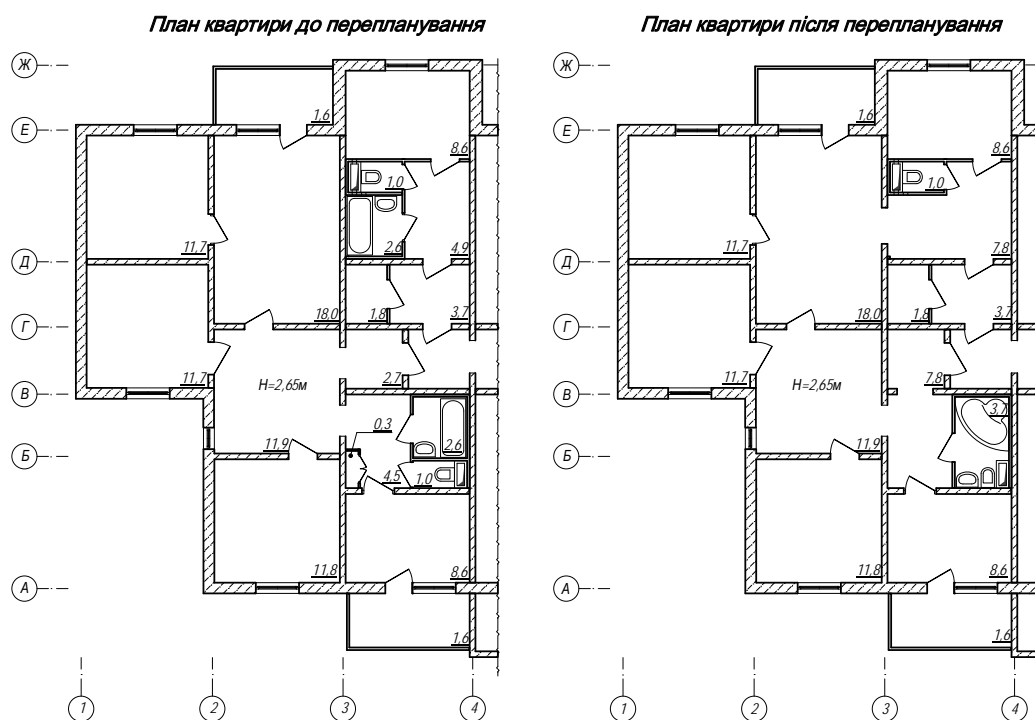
Найбільш поширений варіант перепланування п'яти кімнатної квартири в житловому будинку серії КР-134
